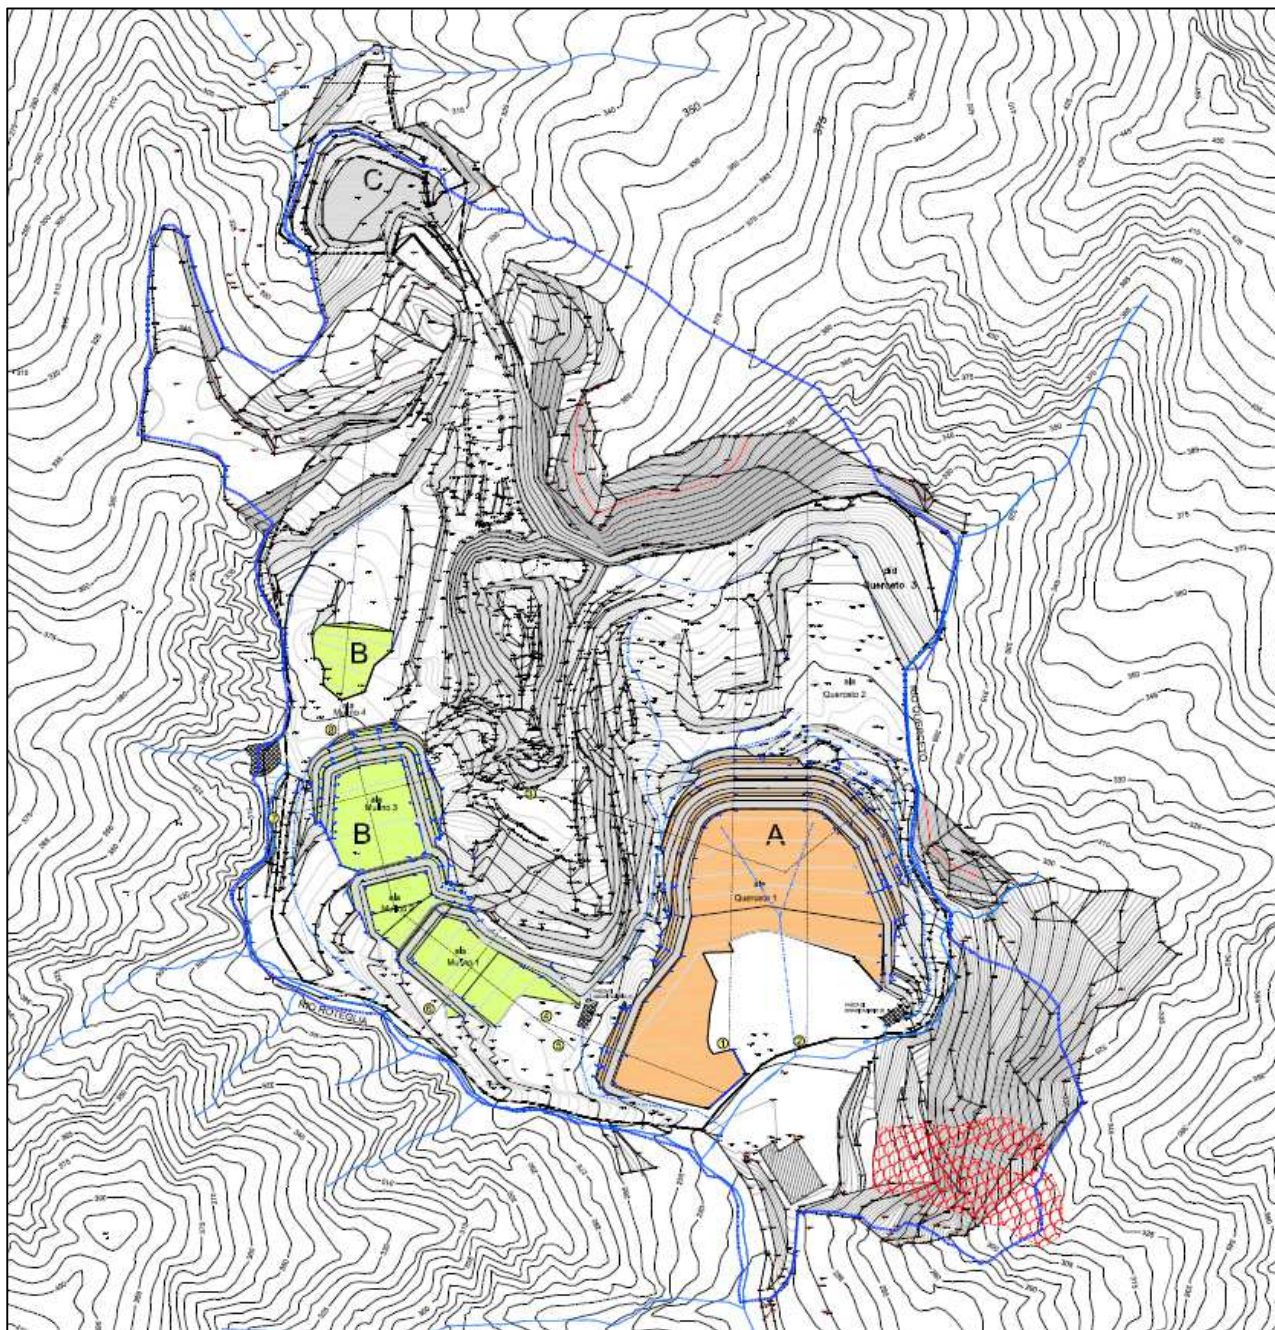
Proposta di coltivazione della Cava Querceto (perimetro in blu), con indicazione della Zona A (area arancione) e della Zona B (aree gialle).
